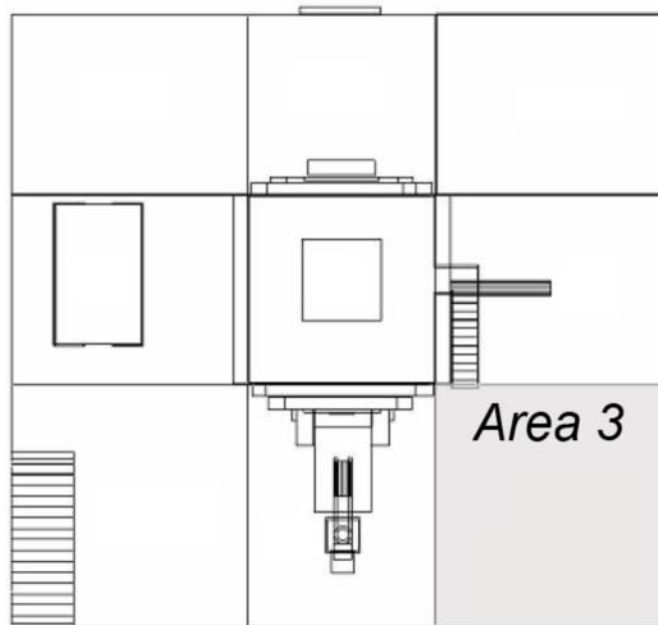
Área 3(hachurada) na planta do salão do reator
